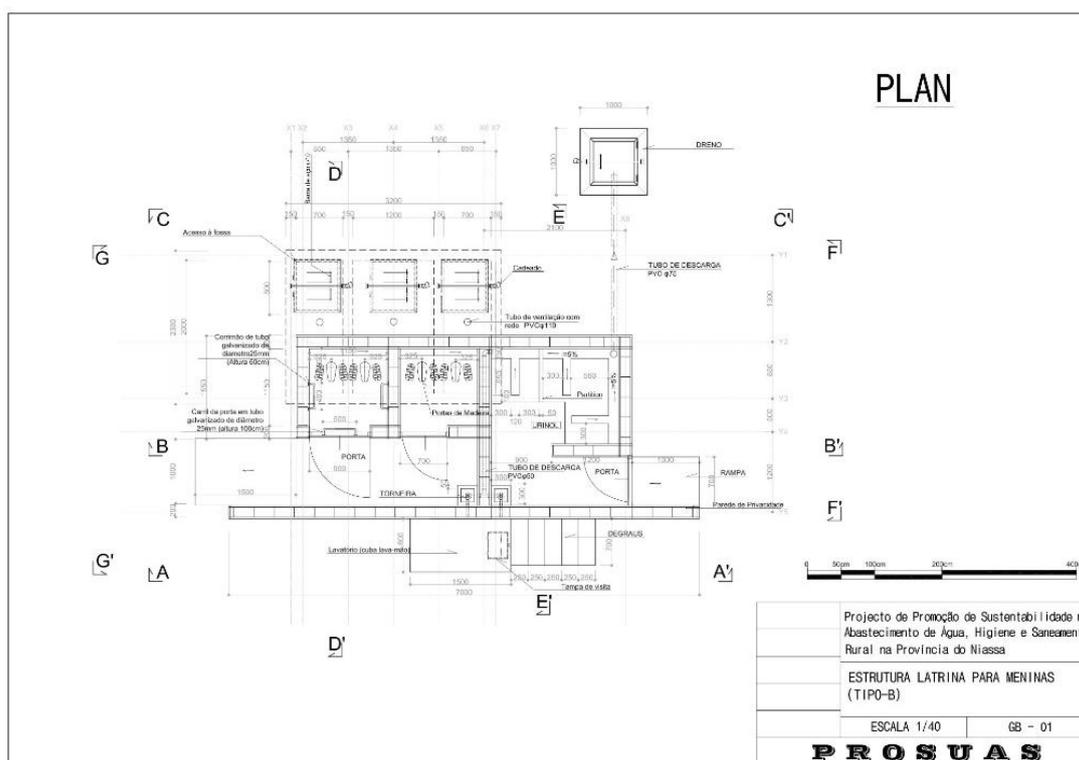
Planta do Bloco Sanitário Tipo B para Meninas
